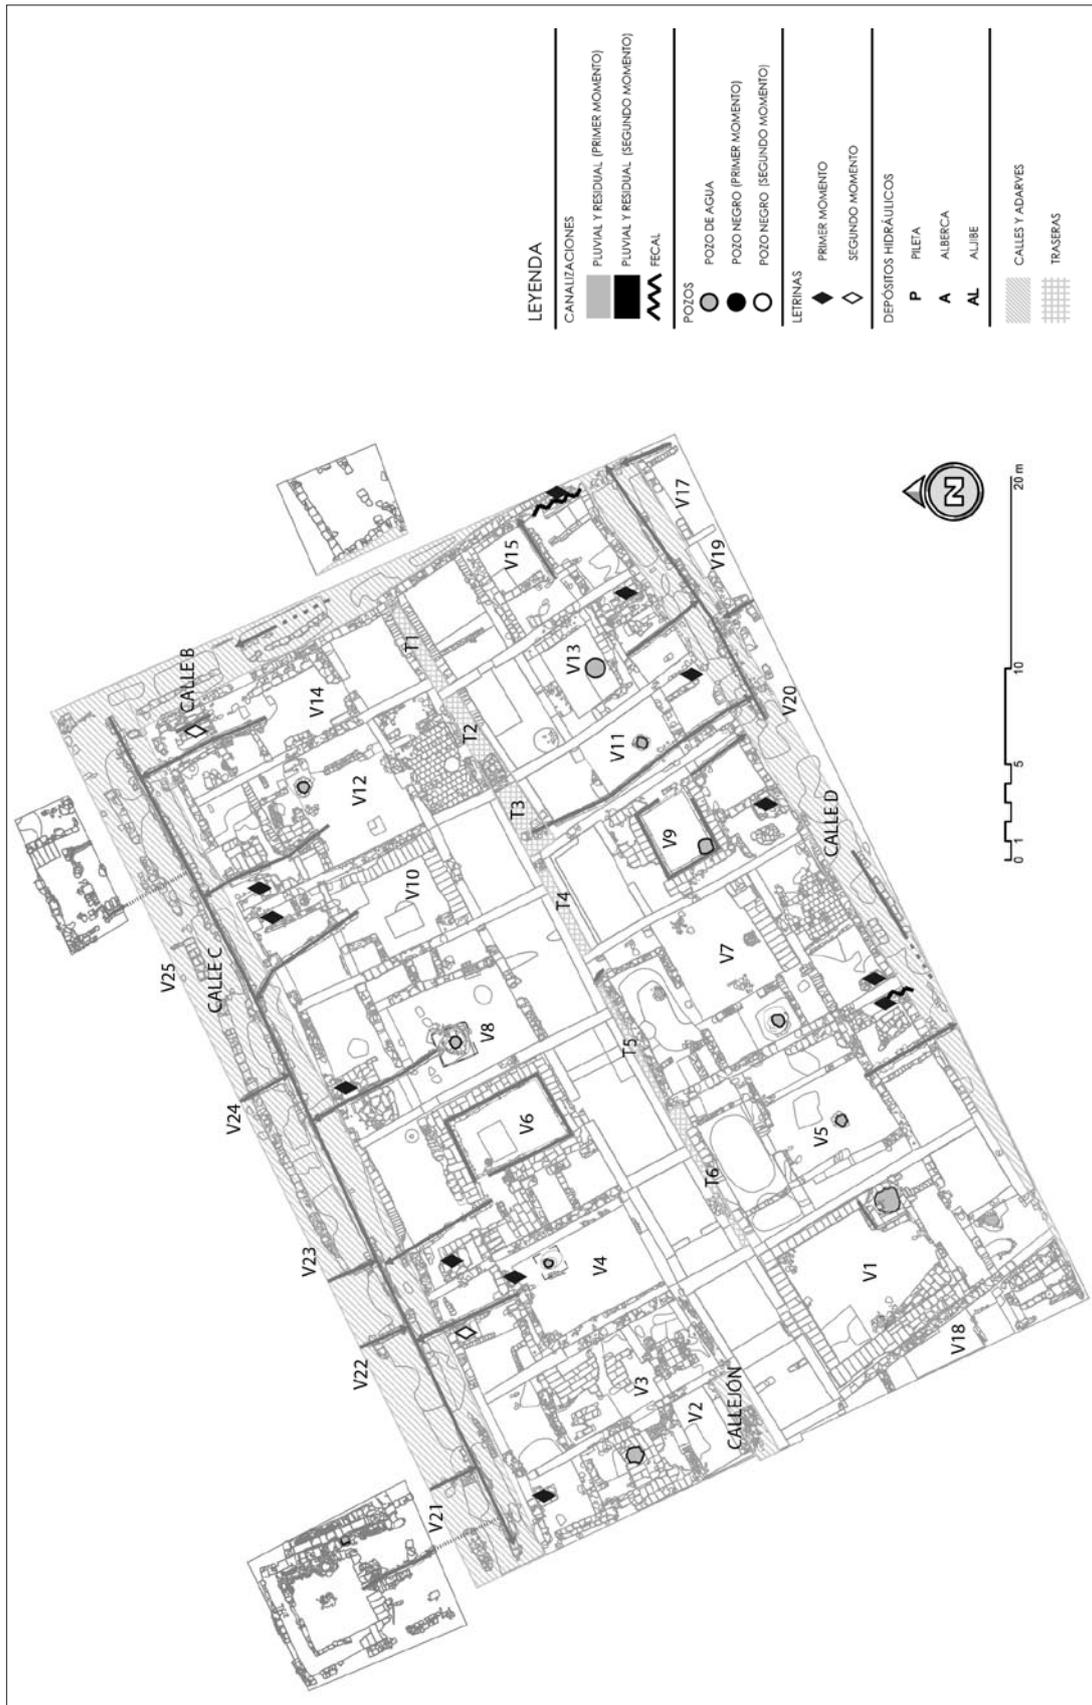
Planta general de la excavación de la Piscina Municipal de Poniente e instalaciones hidráulicas documentadas (sobre planimetría del Equipo de dibujantes GMU-UCO, en CÁNOVAS, MORENO y MURILLO, 2005)
